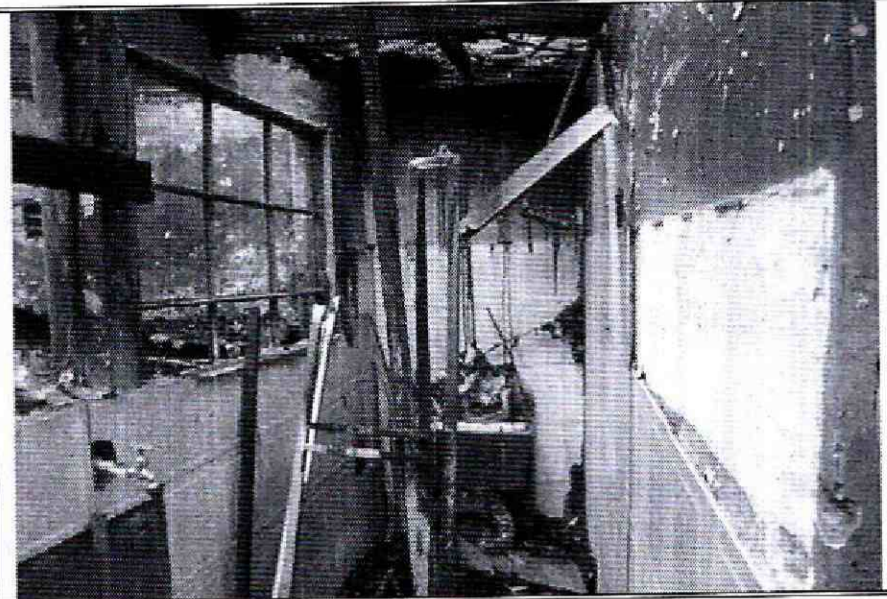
Afectación del baño, en la vivienda de la Carrera 57 No. 17-95.
